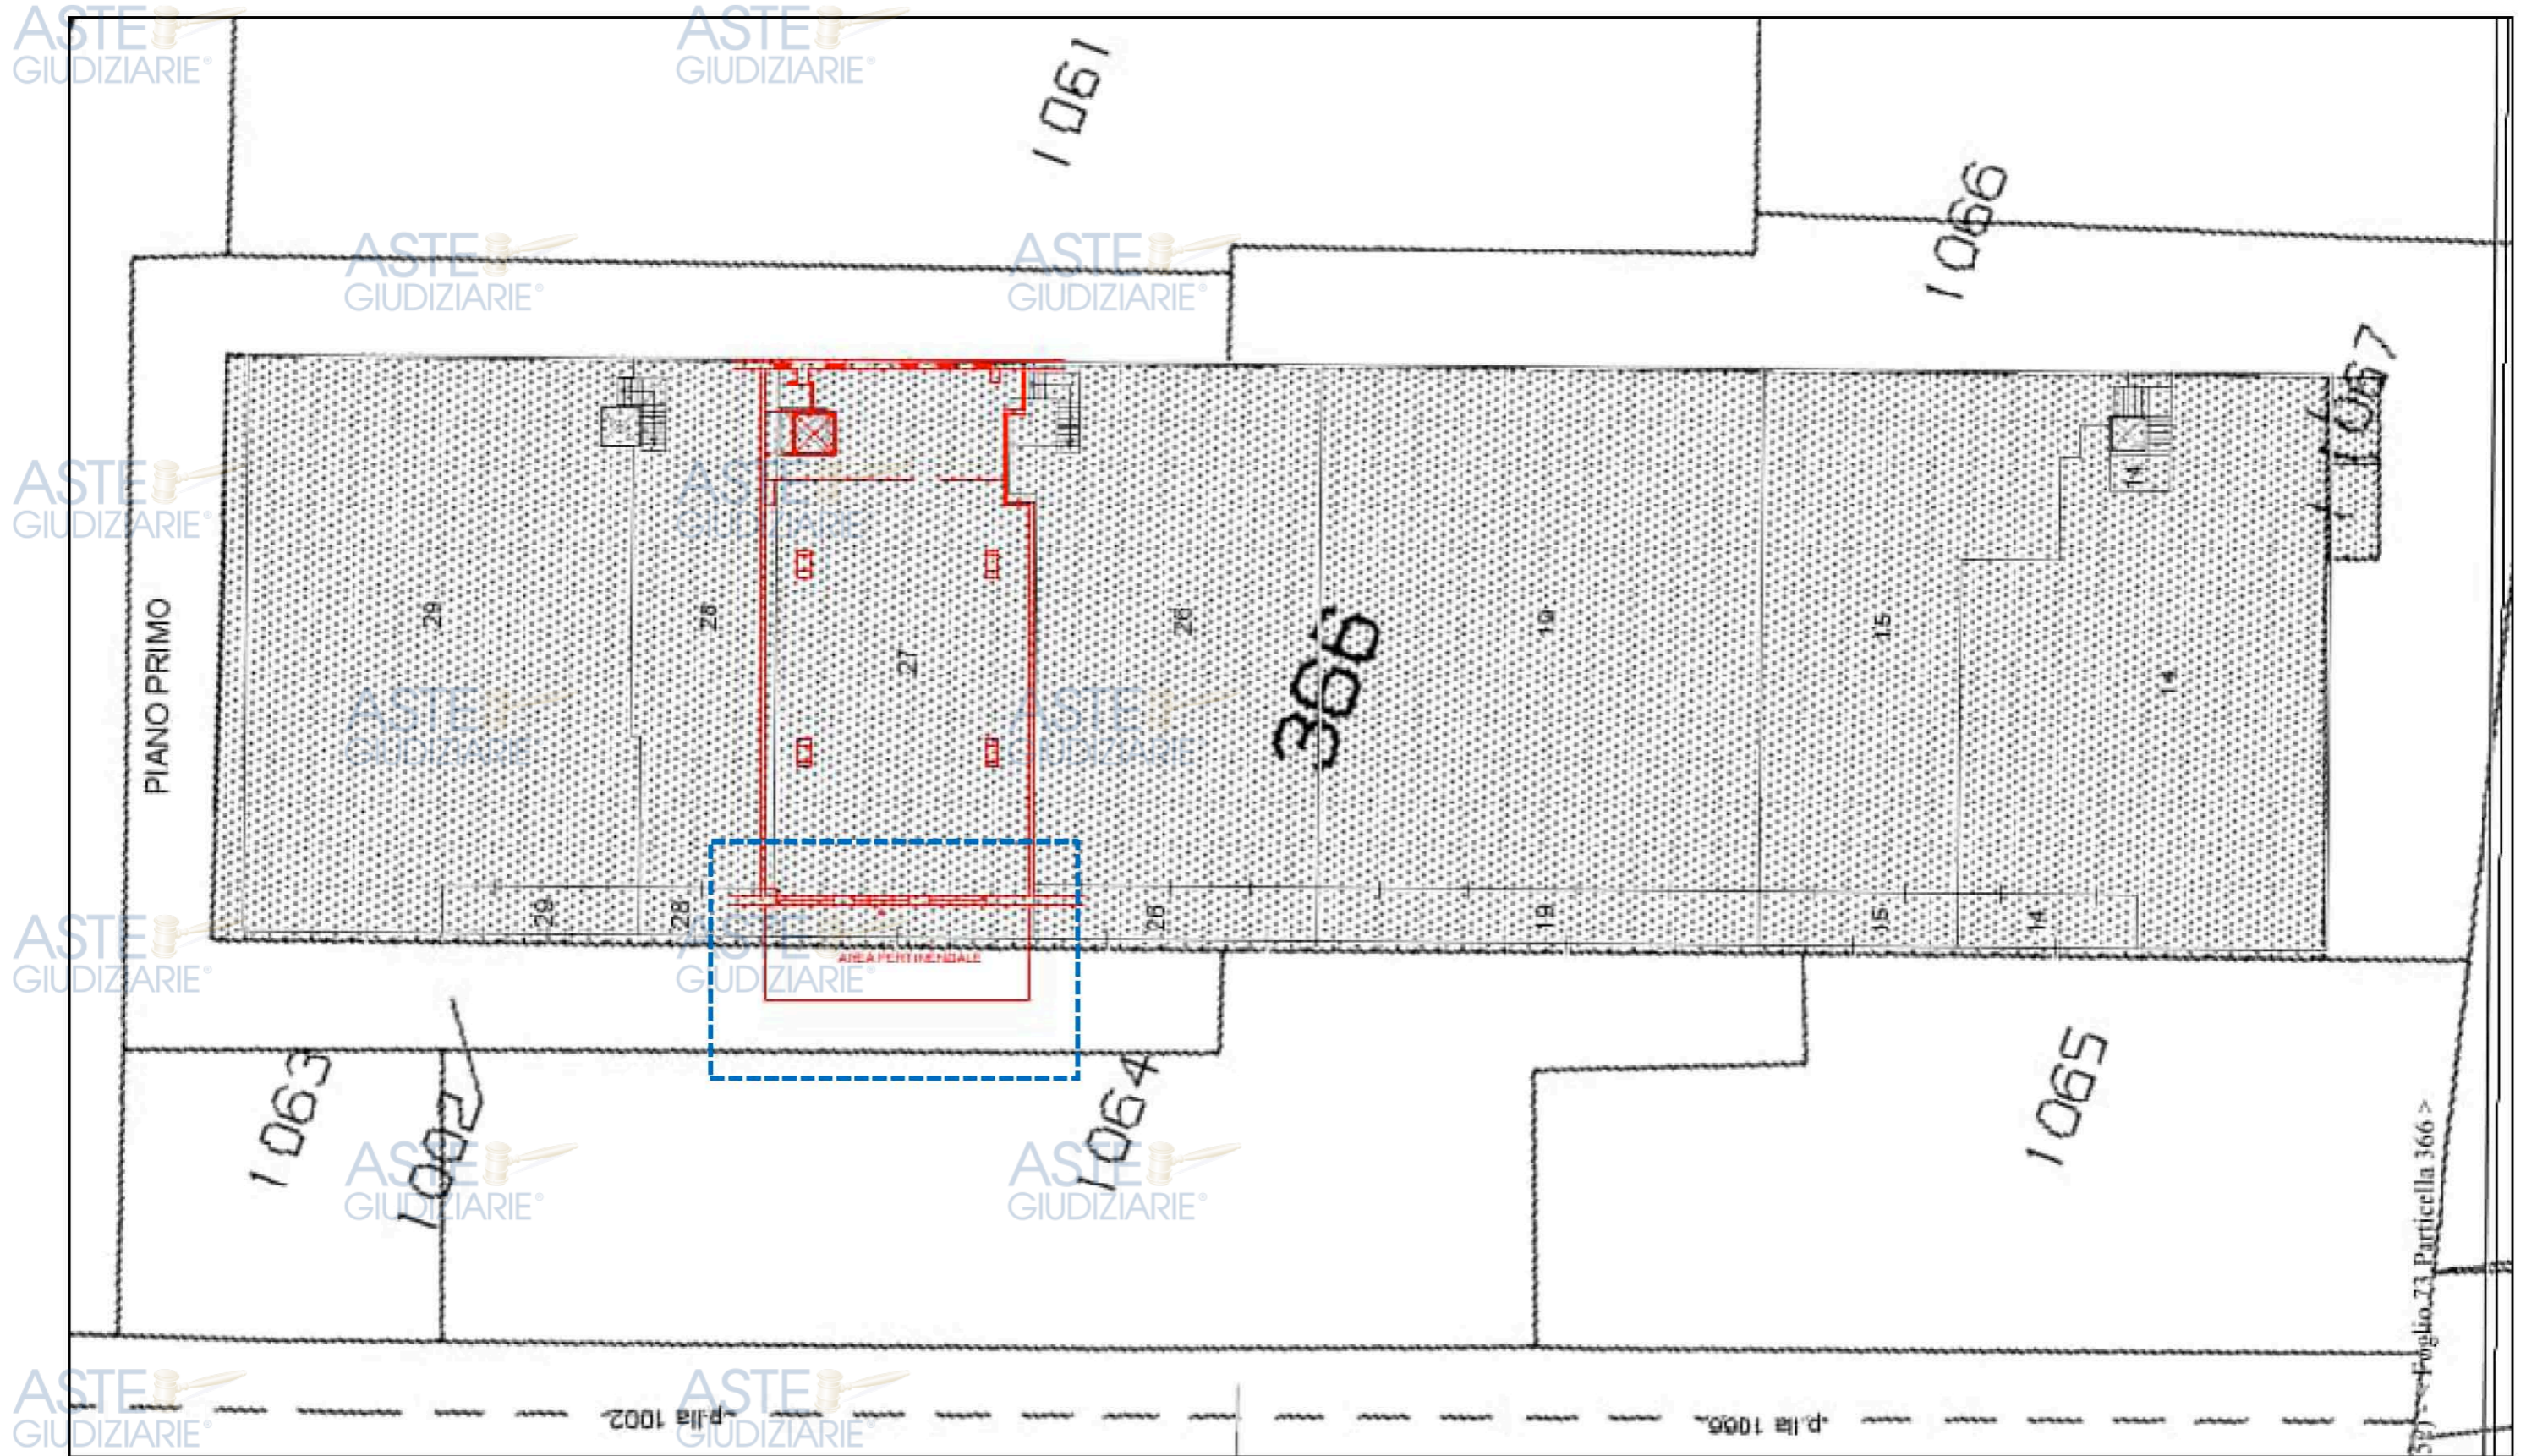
Sovrapposizione tra la planimetria da rilievo del subalterno 27, elaborato planimetrico della particella 366 ed estratto di mappa catastale del foglio 73 – Individuazione area pertinenziale del subalterno 27
